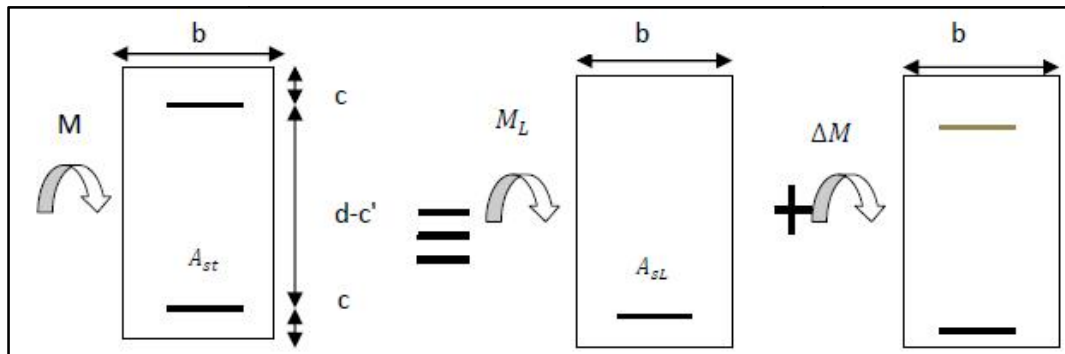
Schéma de Ferraillage des poutres doublement armée
